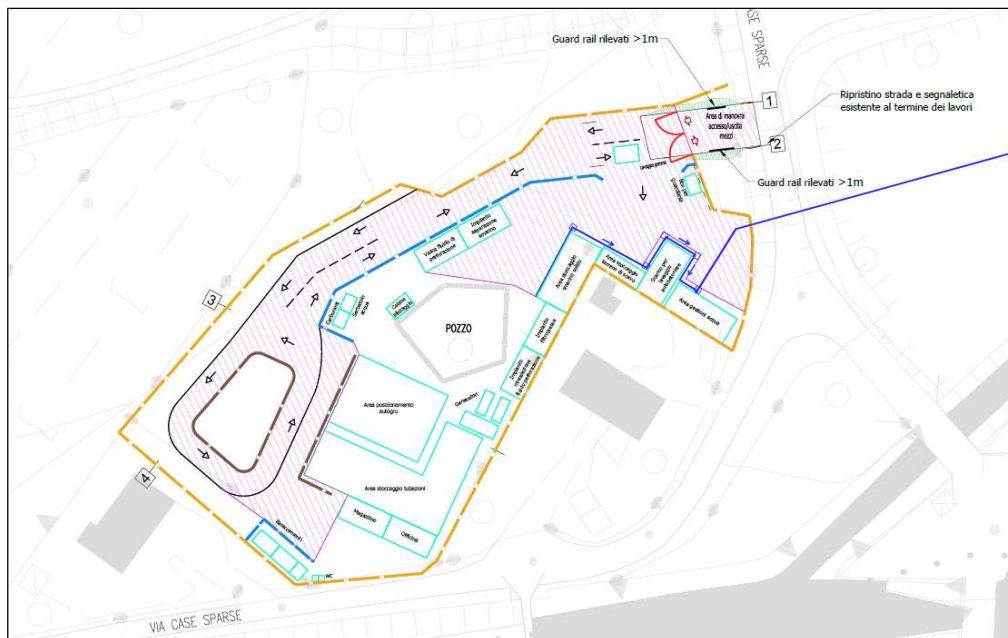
Area di cantiere M1 e Viabilità di accesso
